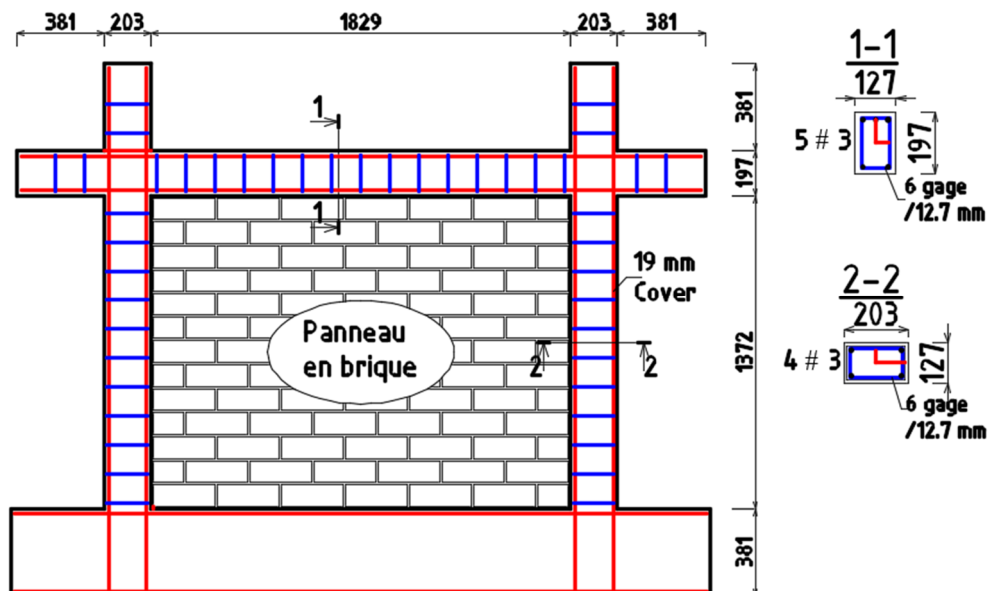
12: Coffrage et ferrailage du spécimen étudié « N3 »
